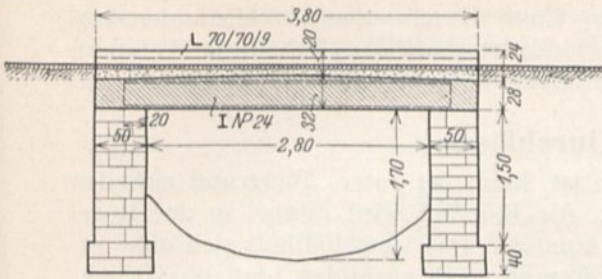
Plattendurchlaß mit Platte aus Stampfbeton zwischen eisernen Trägern auf der Domäne Rodenberg a. D. (Ausführung: „Cementbau“ Ges. für Bauausführungen m. b. H., Hannover.)
